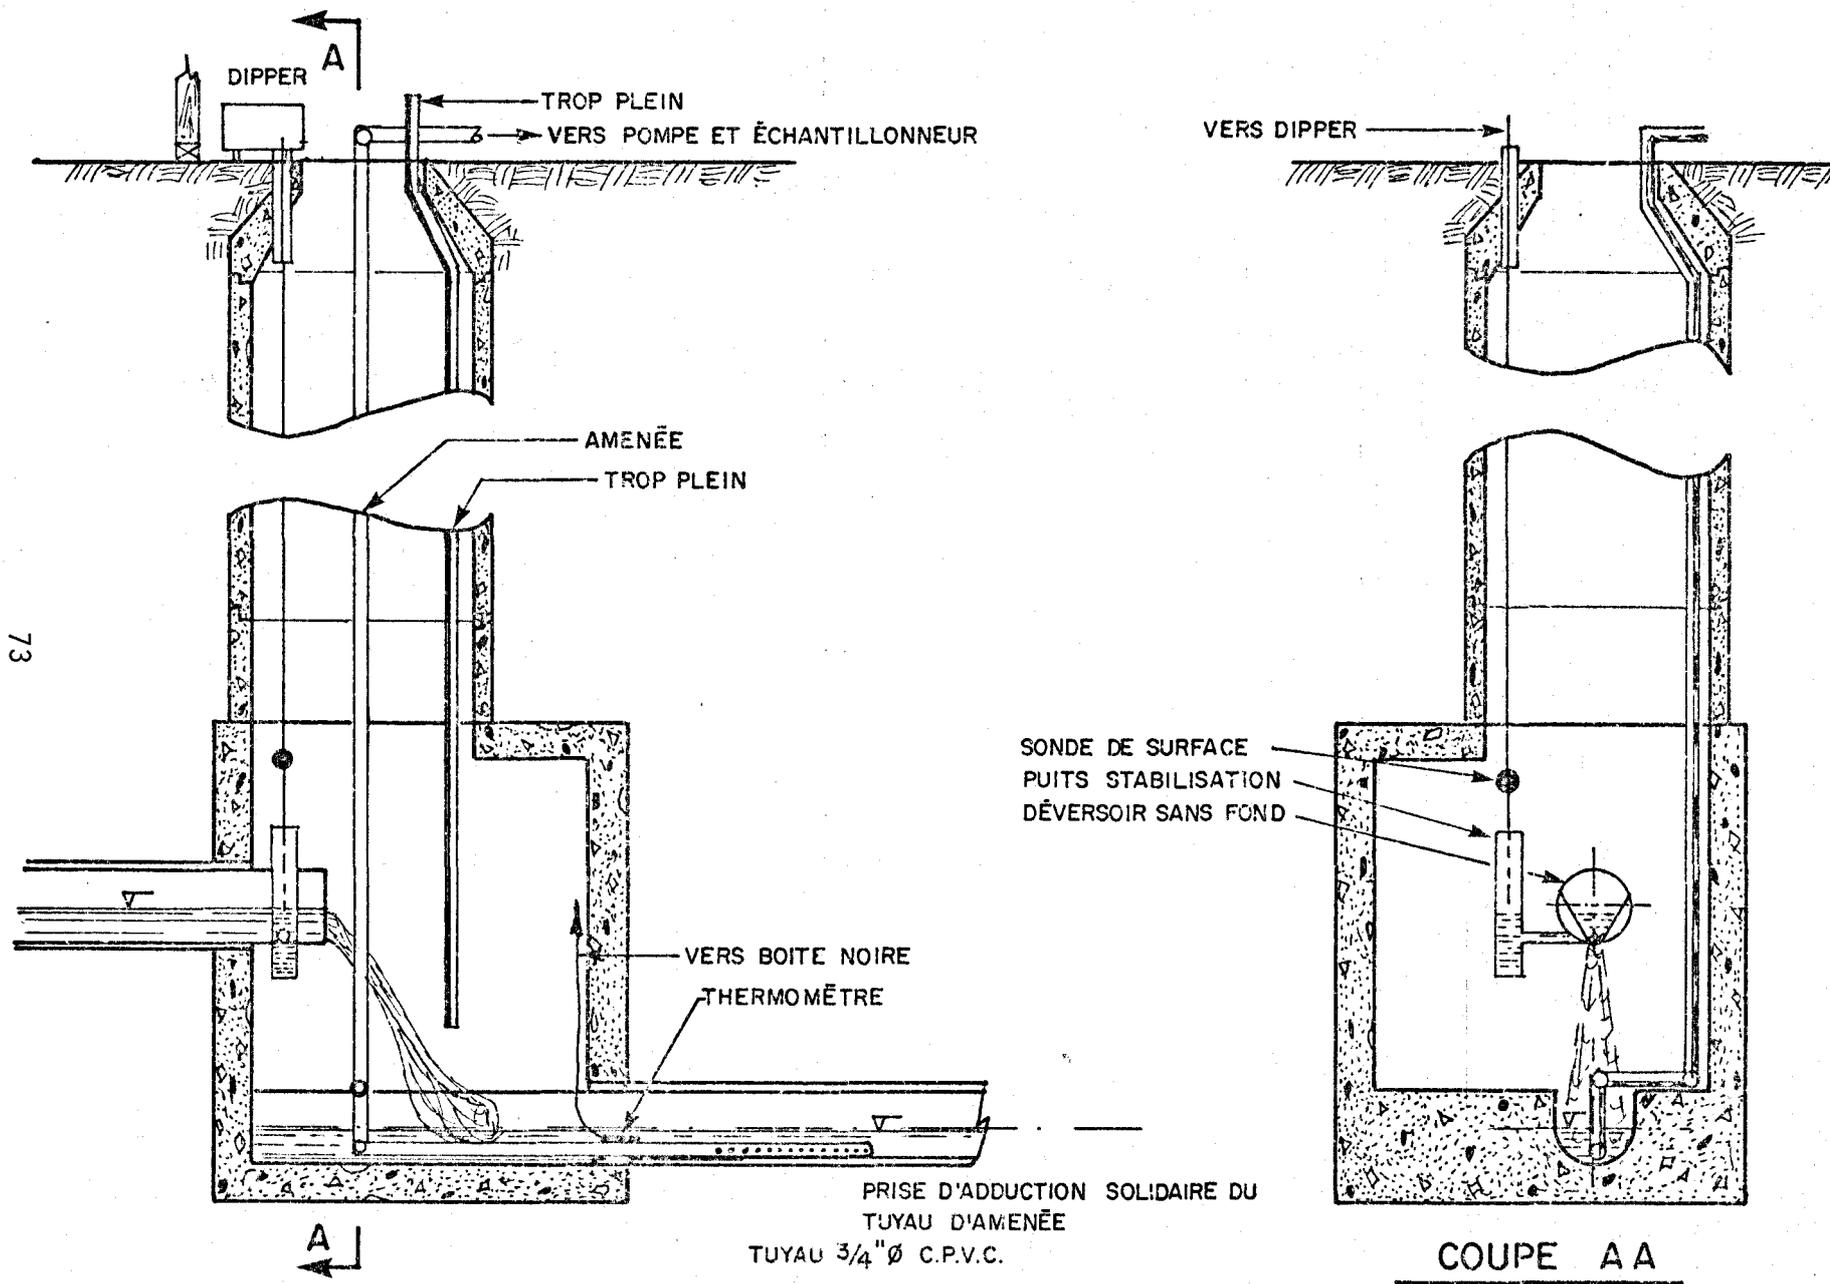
Élément primaire dans une conduite. Installation typique sans saut ( Ste-Foy, Québec ).
